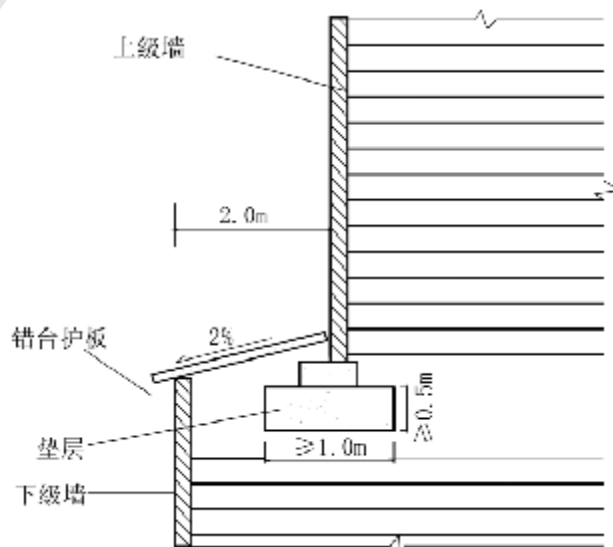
多级加筋土挡土墙中平台与垫层横断面图
